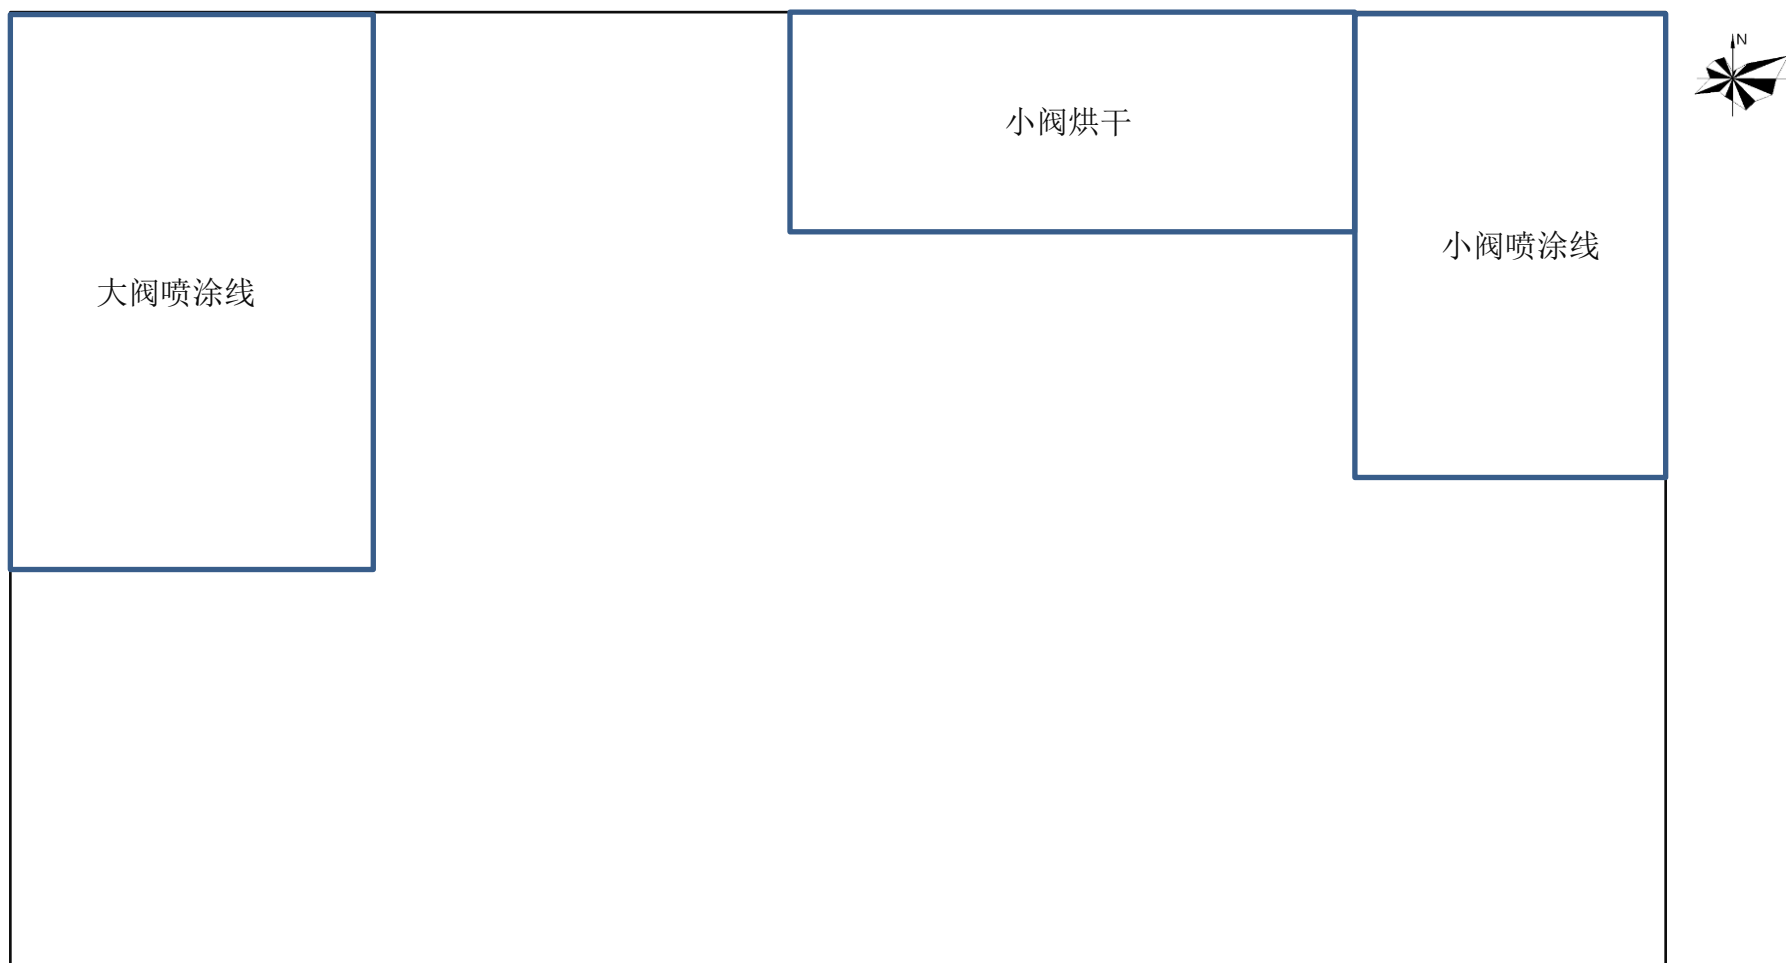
建设项目变动后喷漆房具体平面布置图
